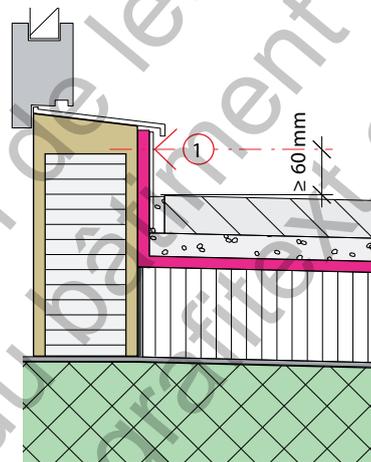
/702: Hauteur de raccordement; bord supérieur ouvert au niveau d'un seuil de porte, fixation (1)
